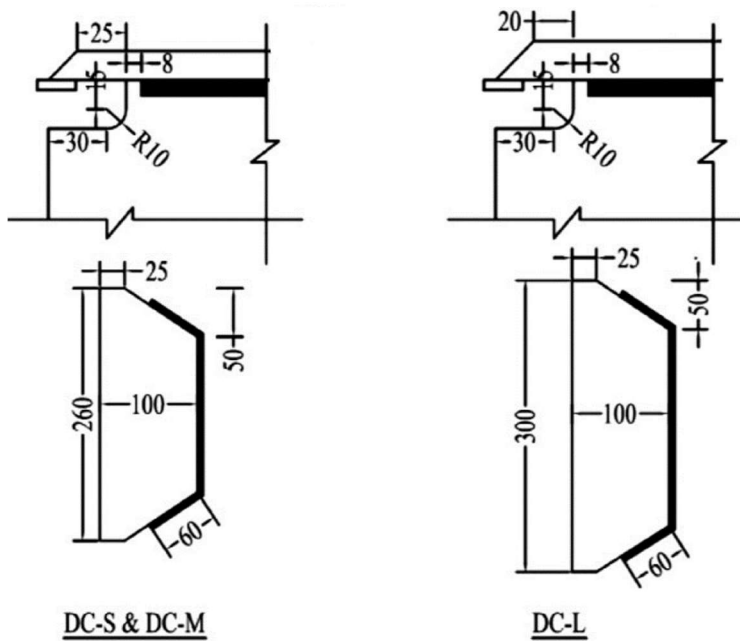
Detalles de agujeros de acceso y placas de refuerzo cortantes de la conexión. Fuente: Saneei, Gassemieh, & Mazroi, 2013, modificado por autora.
